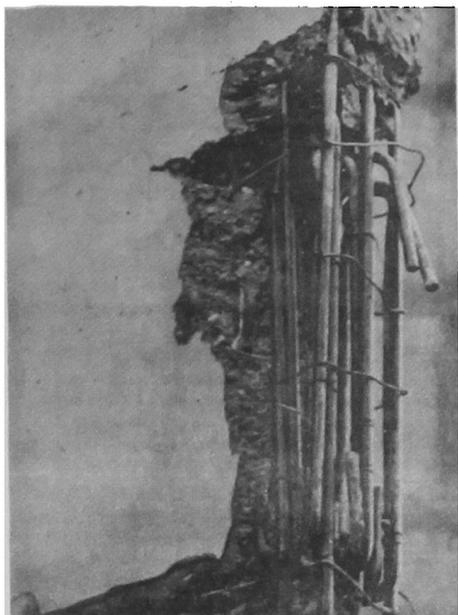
Disposición de los empalmes. Aleta 2. (La armadura ha sido descubierta para observación).
